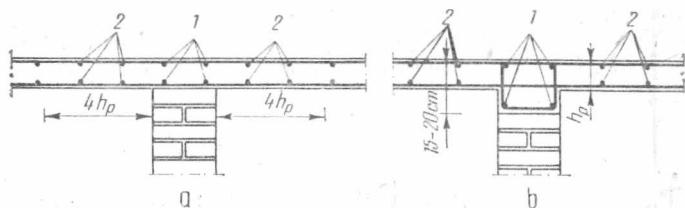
Centuri la planșee din beton armat monolit :
